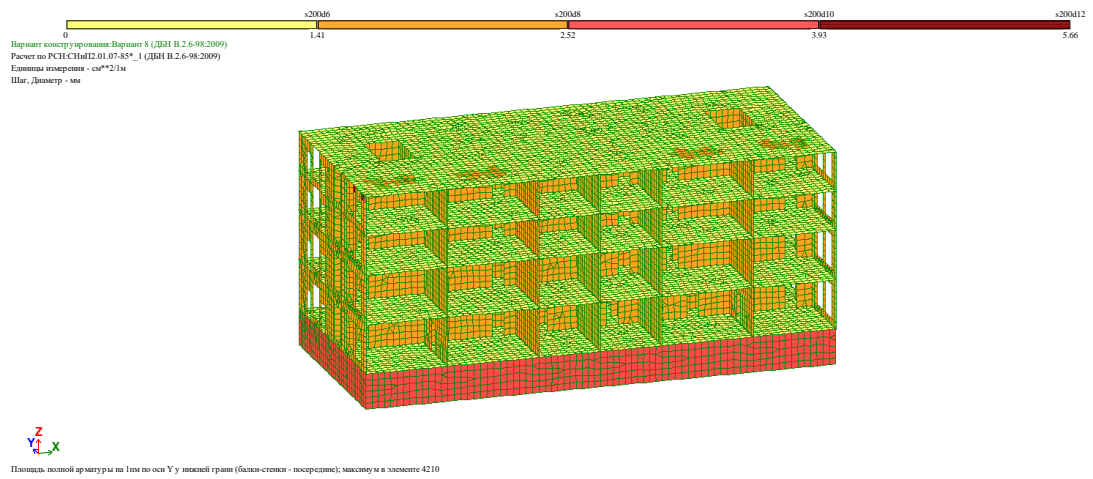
Площа повної арматури на 1м оп осі Y у нижній грані
